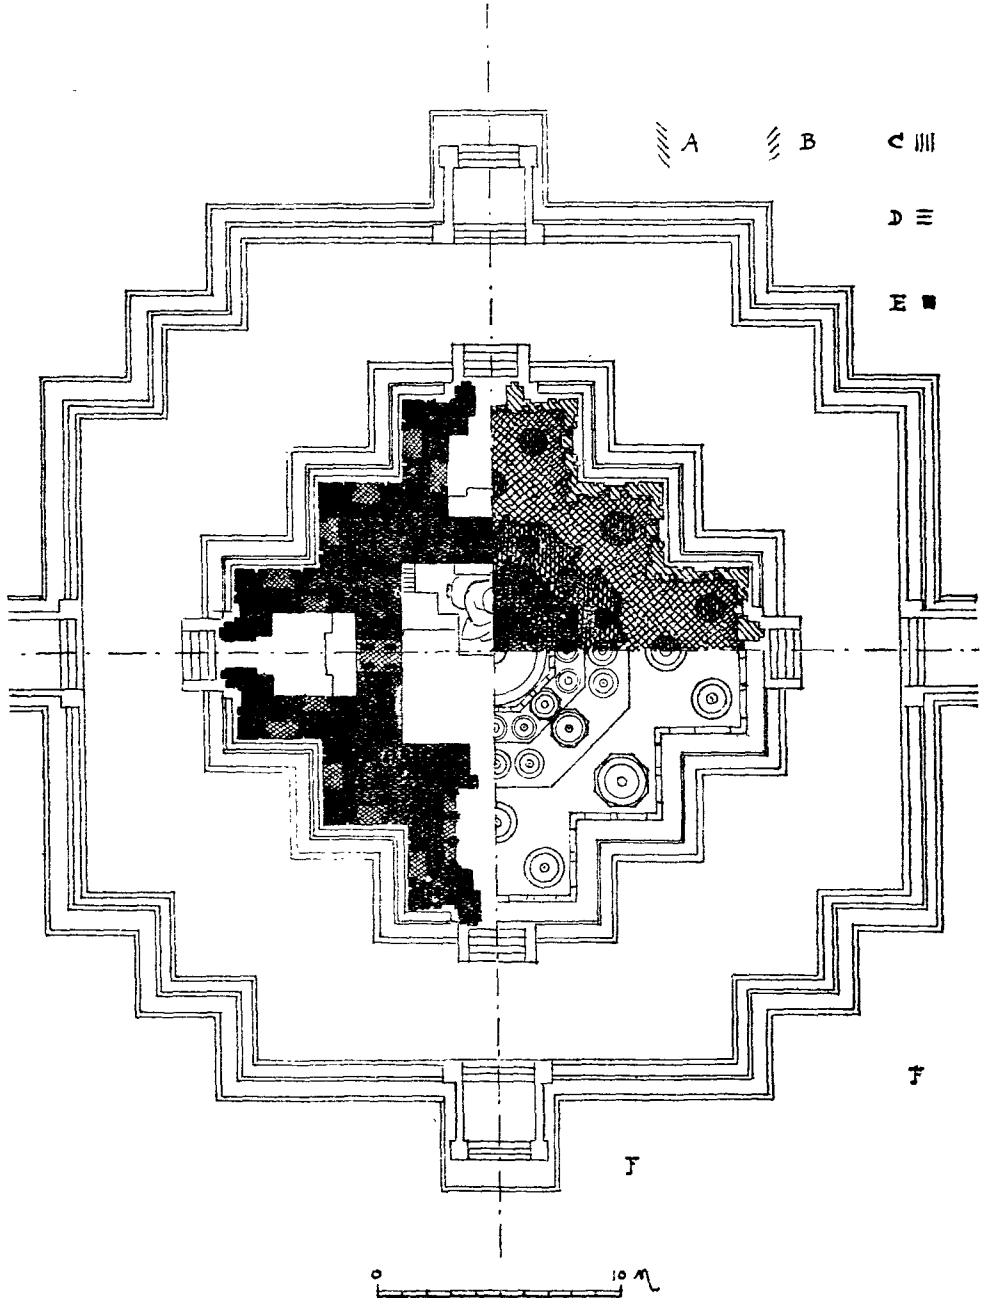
CANDI KALASSAN — PLAN — Echelle : 1 : 6000.
